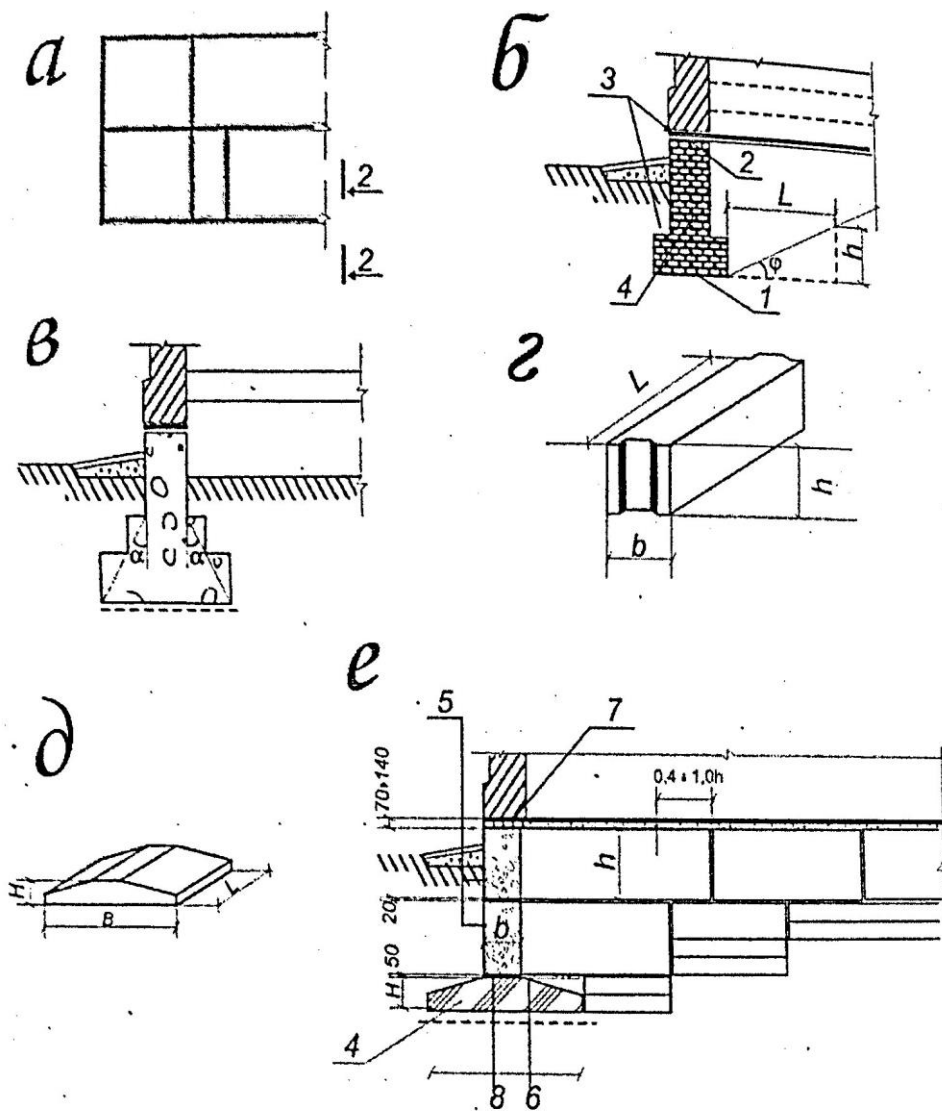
Конструкции ленточных фундаментов под кирпичные стены:
